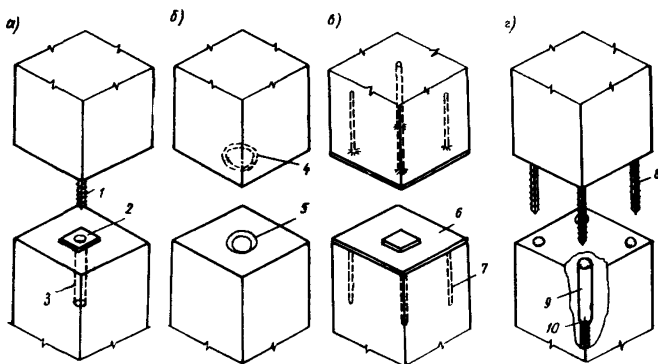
Типы контактных стыков сборных железобетонных колонн с обрывом продольной арматуры
